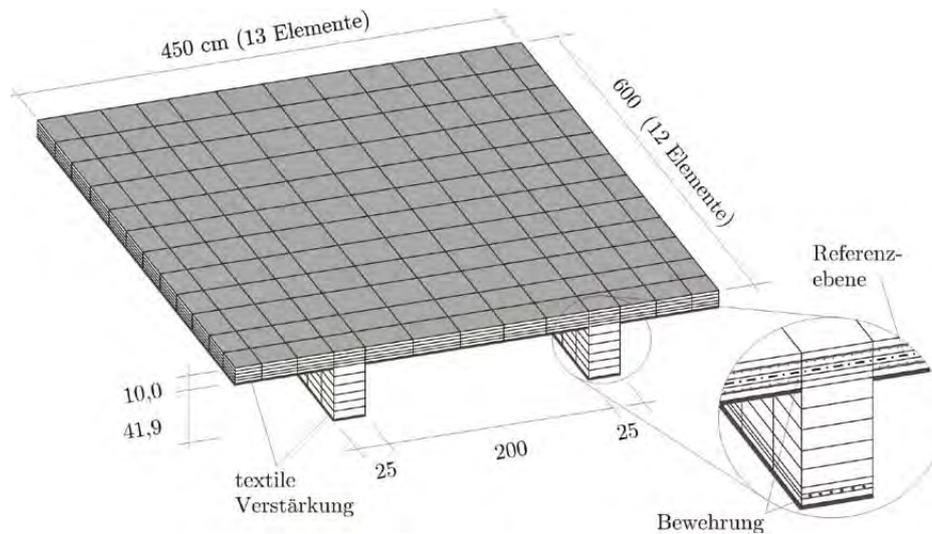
Finite-Elemente Modell einer textilverstärkten Plattenbalkendecke [5]
